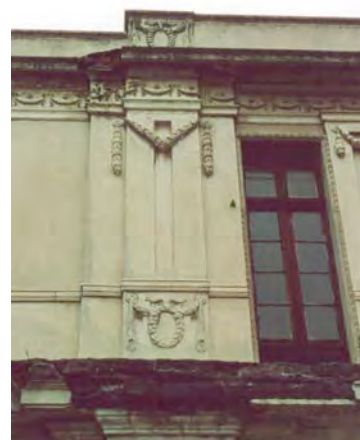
Detalle de la ventanería en planta baja y en planta alta. Obsérvese la vegetación parásita en la cornisa que divide la planta baja y el primer piso. Fotografía tomada in situ año 2000.
